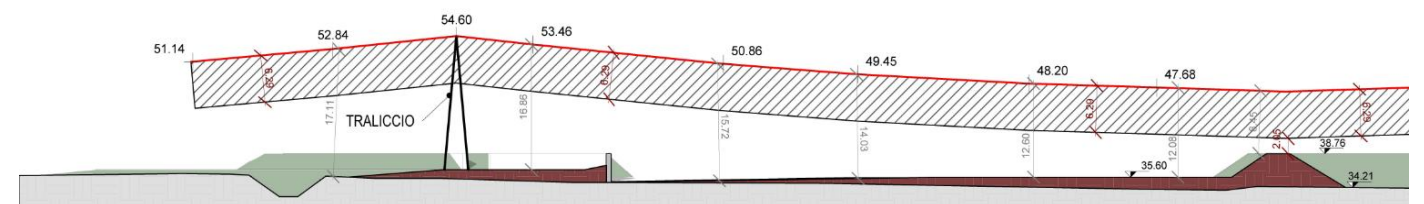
Elettrodotta Enel con planimetria Stato di Progetto e relativa verifica della corda molle soddisfatta
